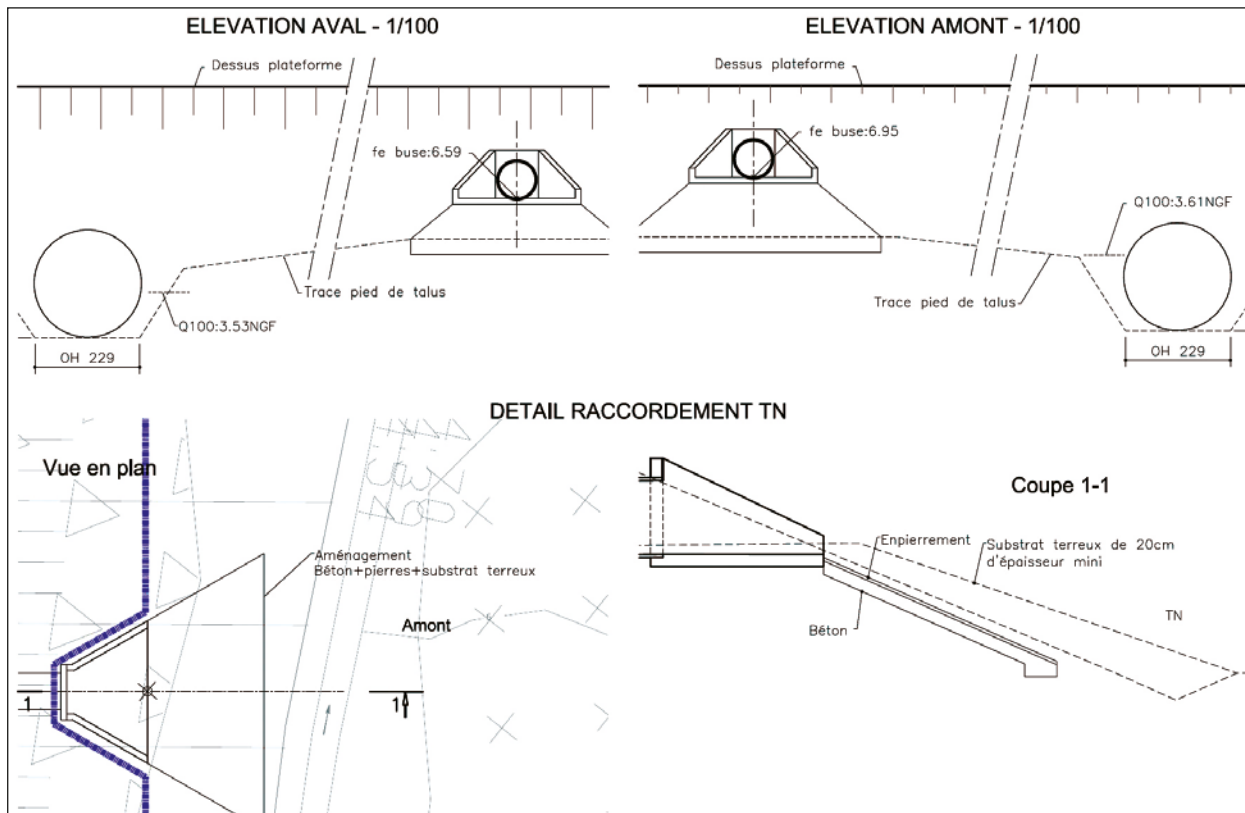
Plan AVP d'un écoduc faisant apparaître le Q100 et les élévations.
